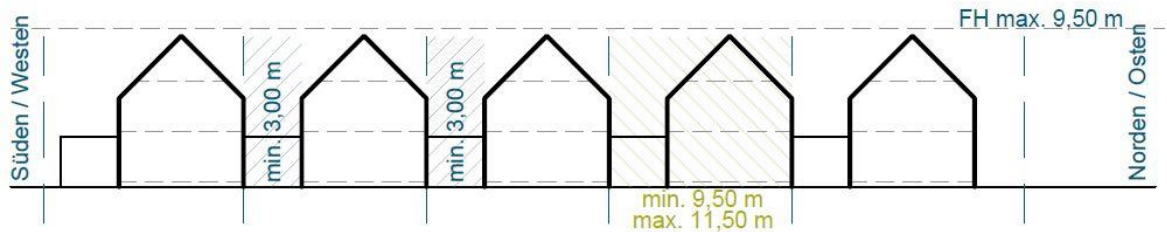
Darstellung der abweichenden Bauweise für Gebäude mit Satteldach – ohne Maßstab
